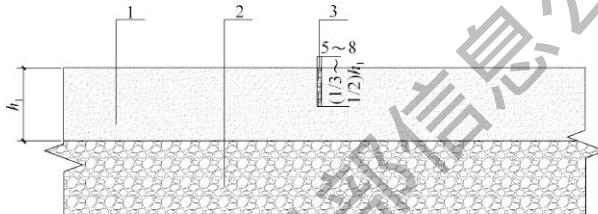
全透水水泥混凝土路面缩缝构造（单位：mm）
